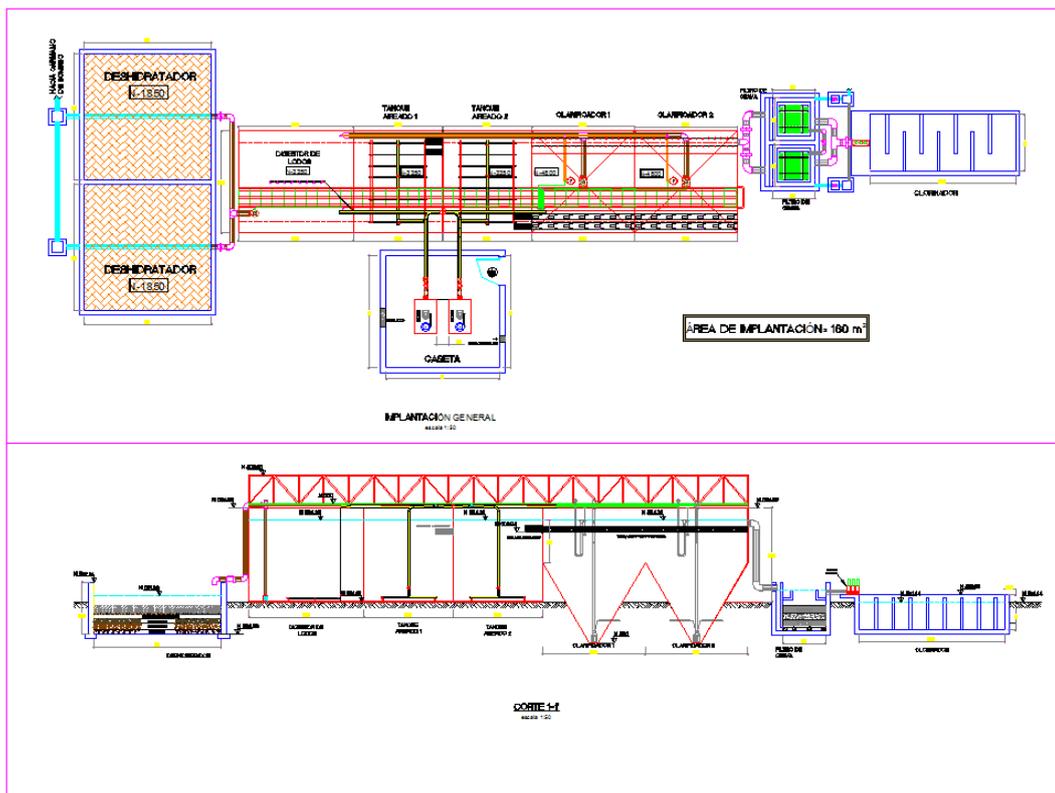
Planta de tratamiento de aguas residuales. Campamento de construcción
